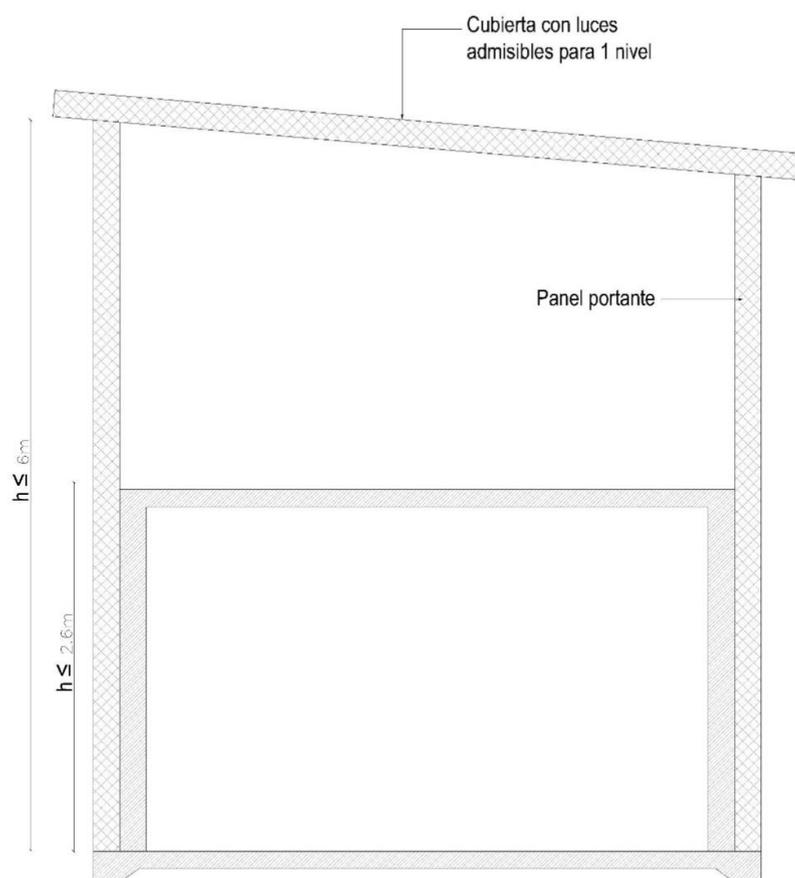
Esquema estructural en tipologías de dos niveles. Estructura independiente de entresijos.
